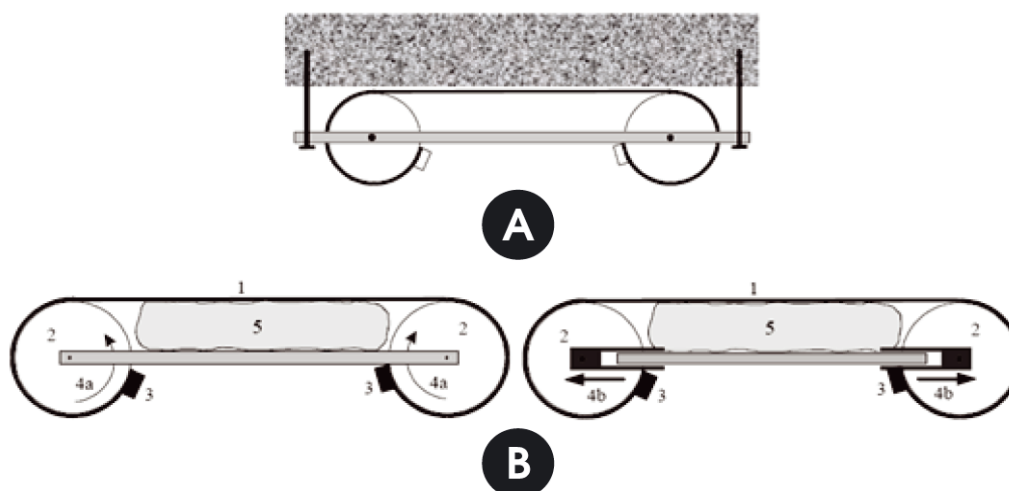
Dispositivo de pretensado desarrollado por Stoecklin y Meier (A) - Colocación del dispositivo de pretensado debajo de la viga; (B) Dos maneras de pretensar una lámina de CFRP [Garcez M.R., G.L. Silva Filho, U. Meier (2012)]
